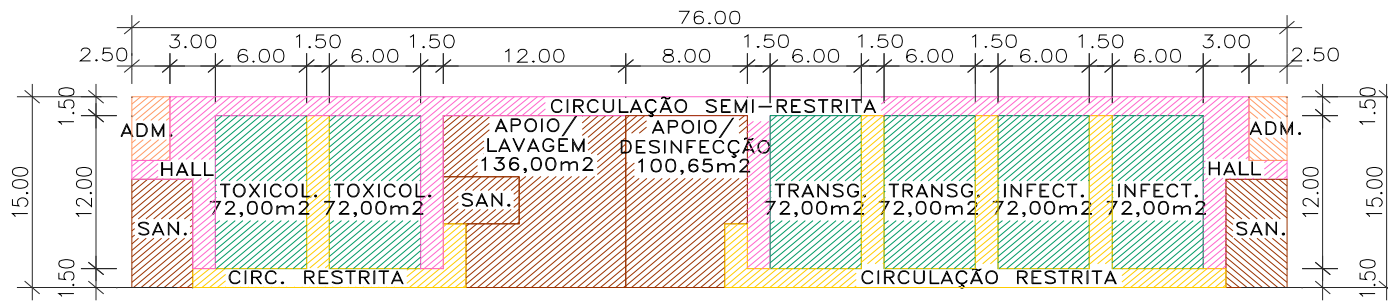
Estudo prévio elaborado pela Fiocruz para o CDTS. Experimentação Animal. Planta Baixa do Pavimento Térreo. Fonte: Acervo da COGIC/FIOCRUZ (2003).
